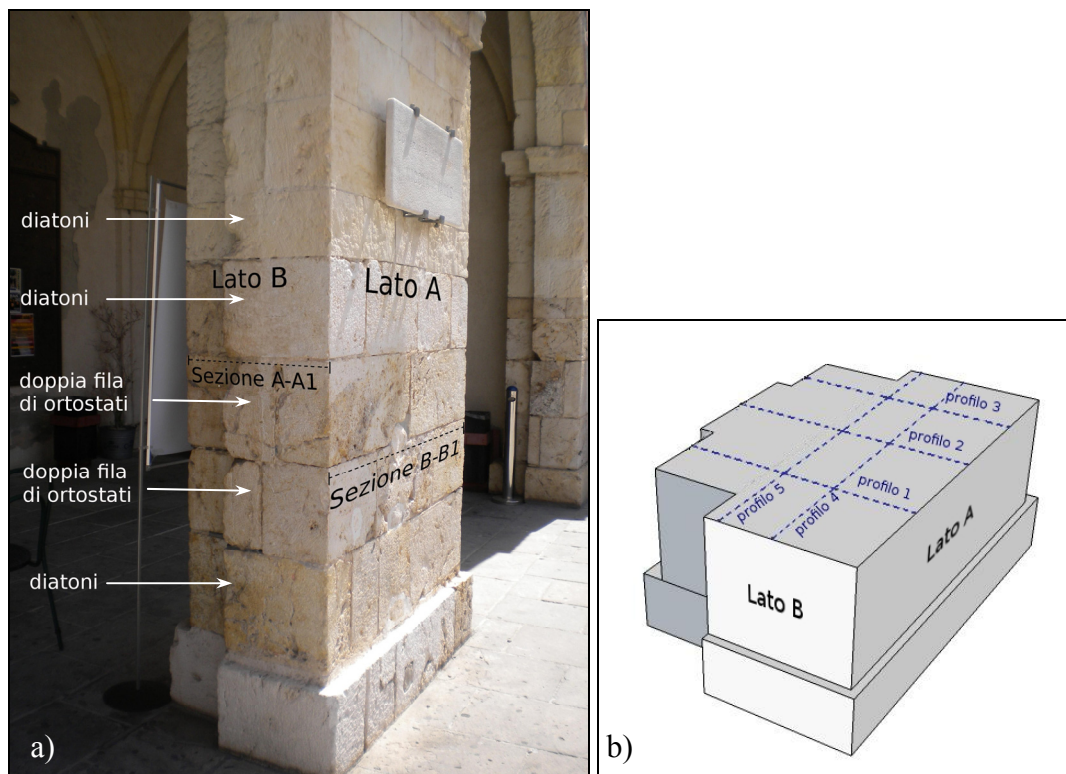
(a) disposizione dei conci del pilastro nelle diverse direzioni; (b) vista semplificata del pilastro in sezione e localizzazione dei profili ultrasonici per trasparenza.
